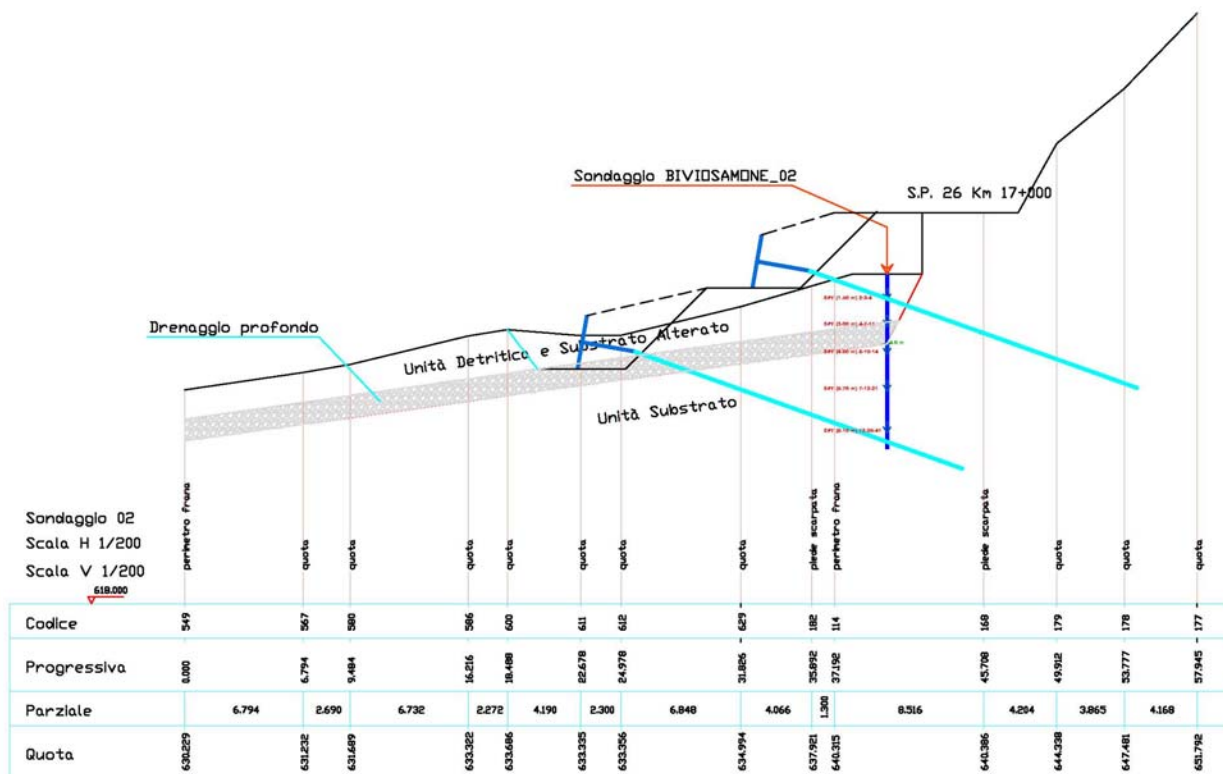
Sezione litotecnica di progetto coincidente con la sezione topografica n. 2
